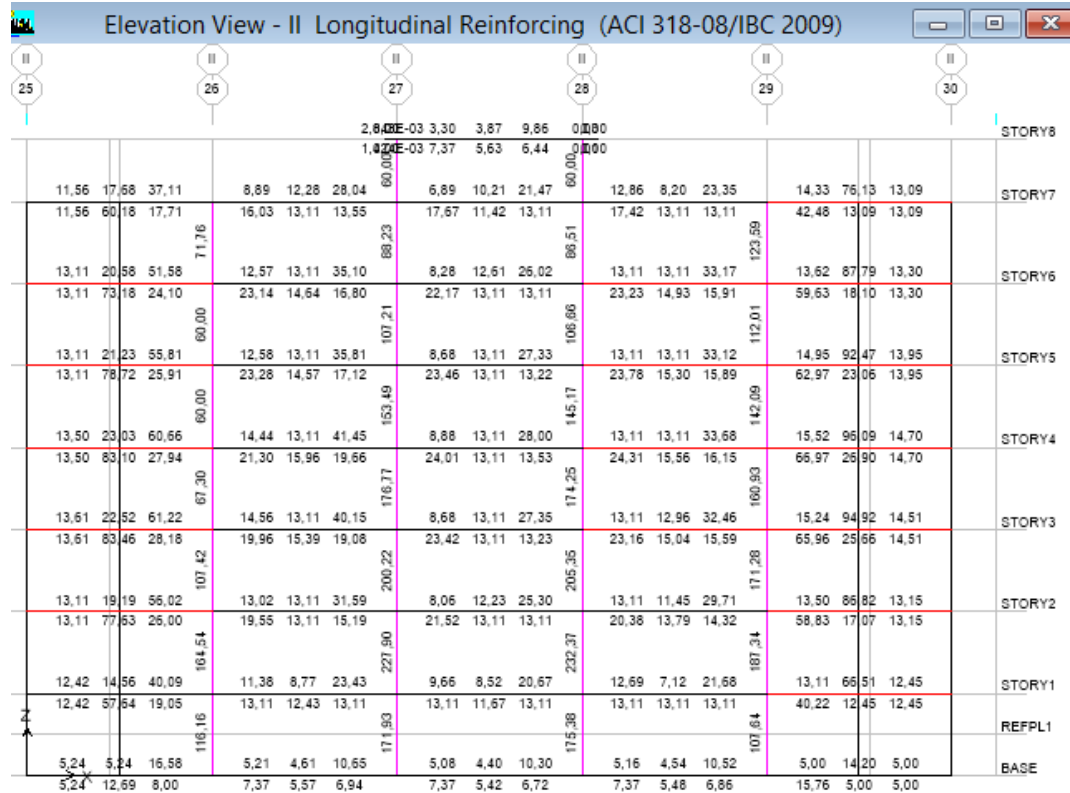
Acero en Vigas y Columnas en el Pórtico II – Hospitalización 2- (LRB+HDR)
